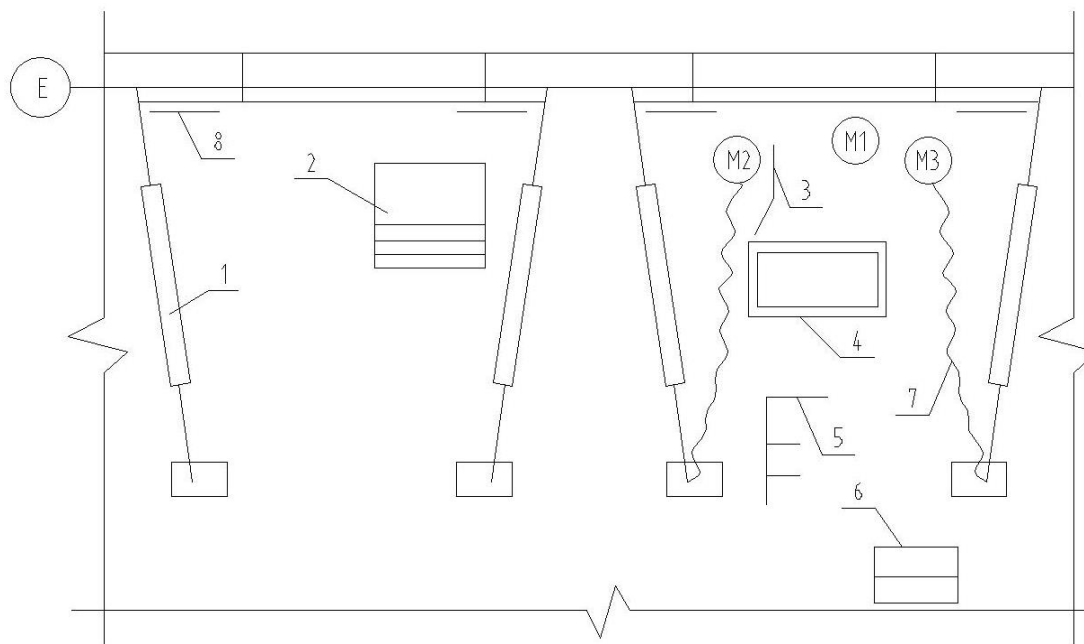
Схема организации рабочих мест при монтаже наружных стеновых панелей:
